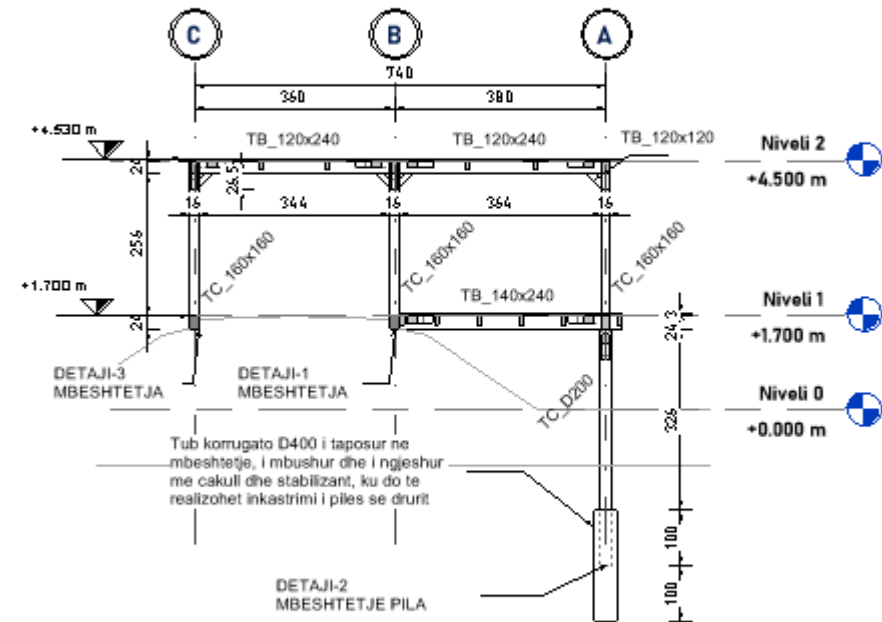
Planimetria e tendes, dhe prerjet kryesore.
